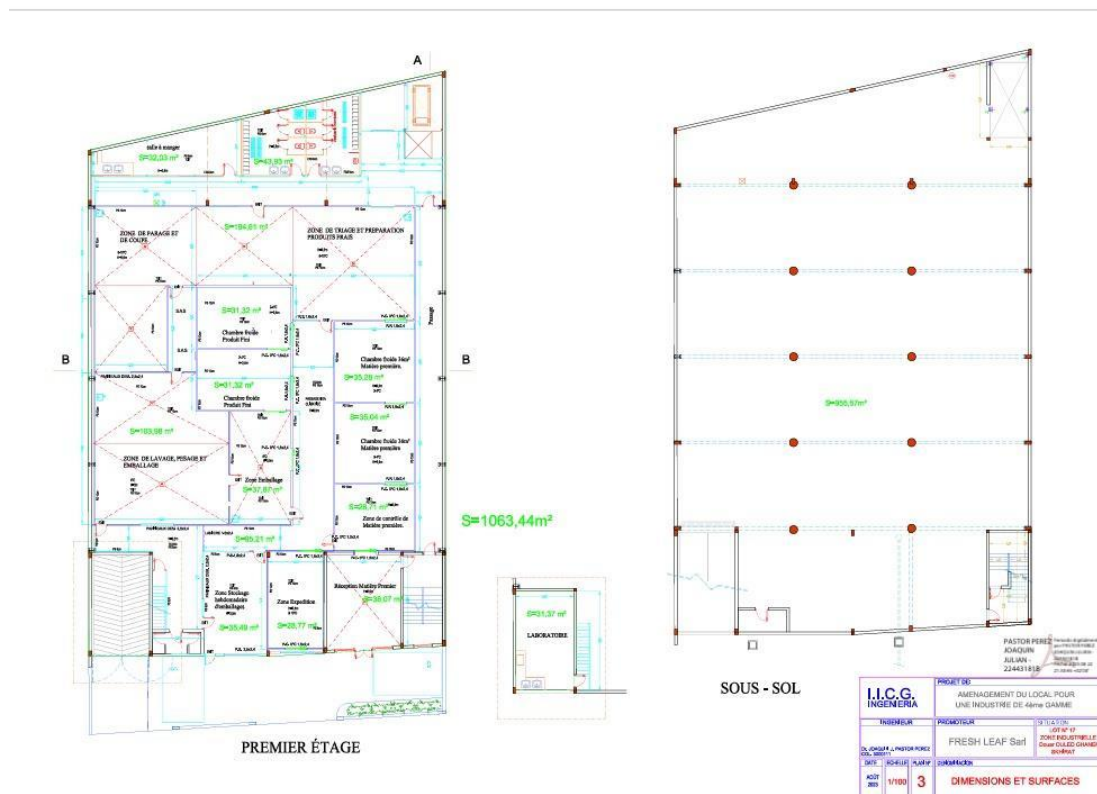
Plan des dimensions et surfaces (premier étage et sous-sol)
